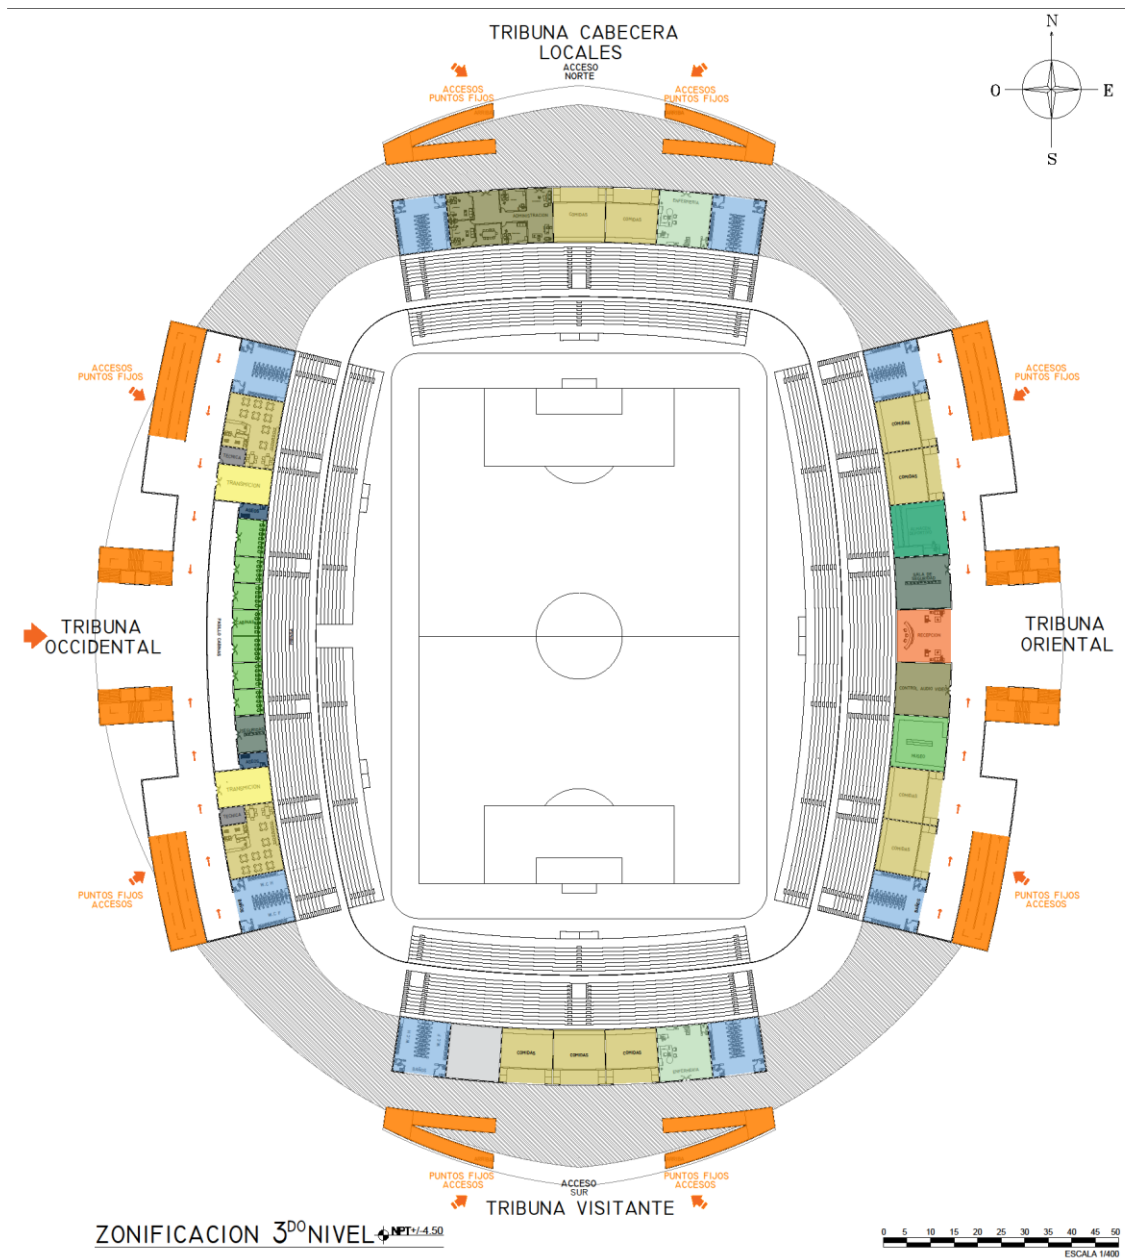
Zonificación Planta 2/ Fuente Elaboración Propia
